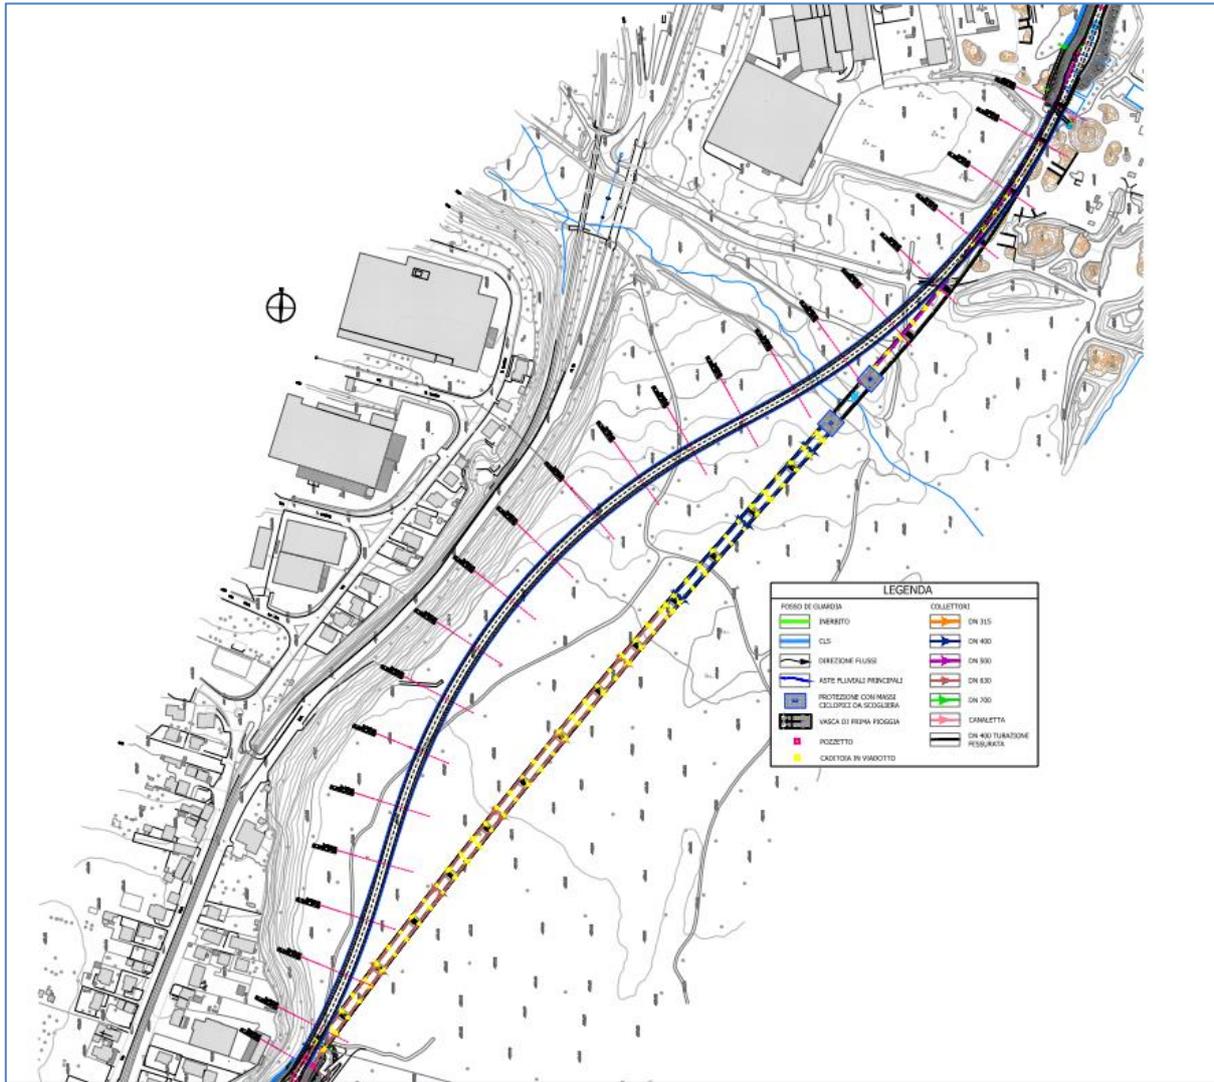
Stralcio planimetria idraulica della variante di progetto presso il Biotopo Risorgive del Piave
